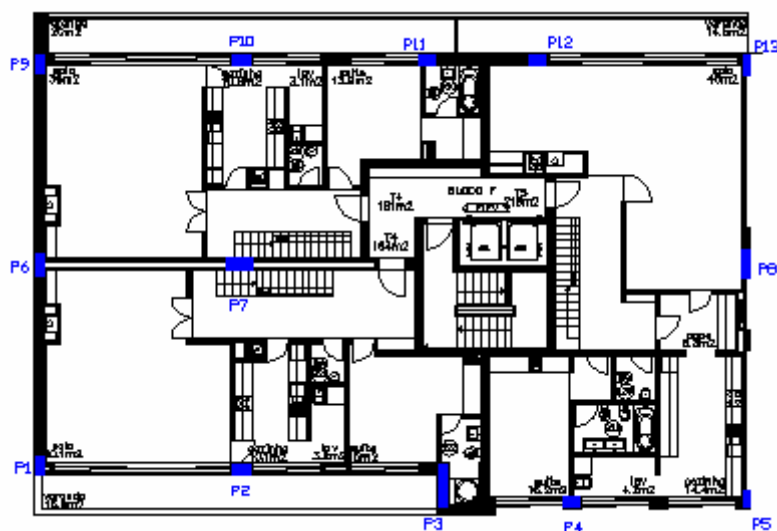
Planta de arquitectura modificada do 6º Piso
